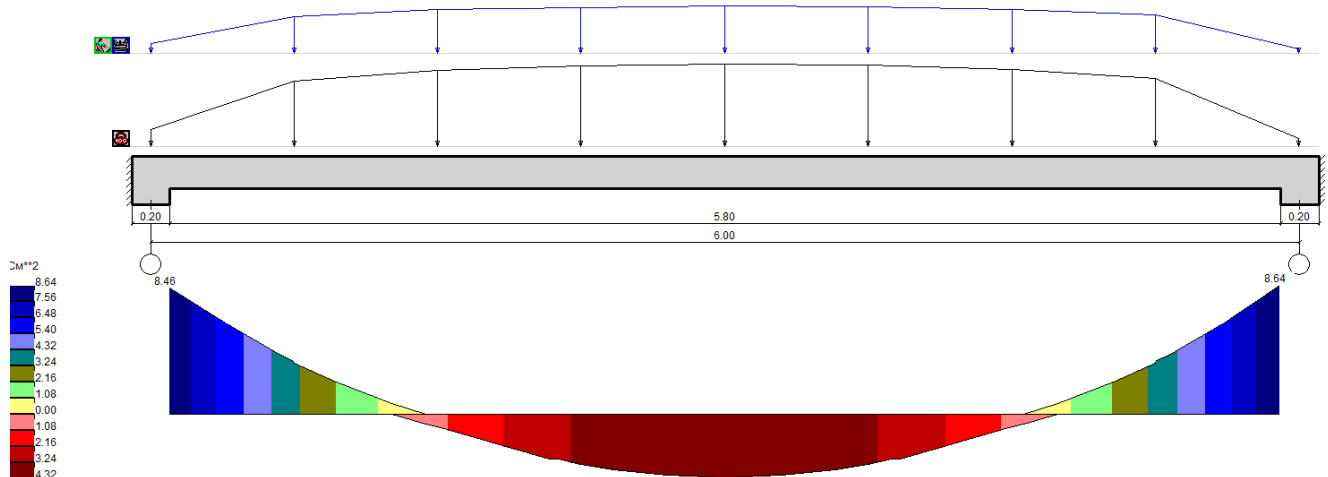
Поздовжнє армування балки перекриття на відм. 0.000
